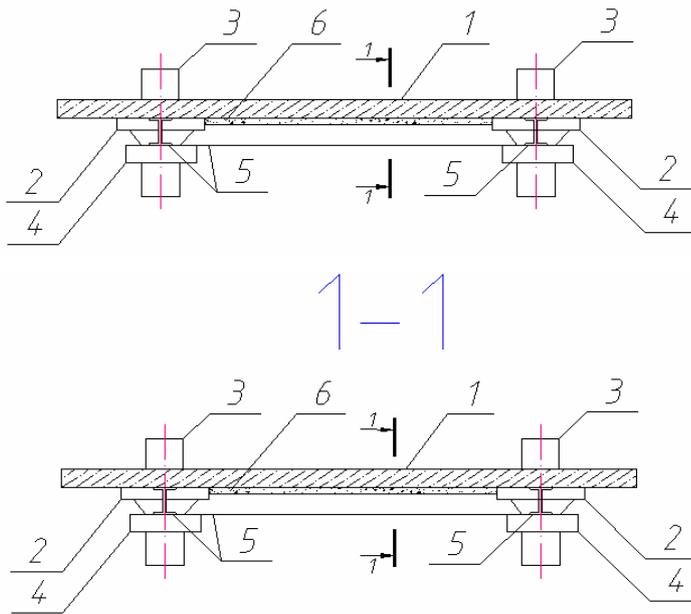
Усиление монолитного безбалочного перекрытия переустройством в плиту, опертую по контуру: 1 – плита существующего безбалочного перекрытия; 2 – капители безбалочного перекрытия; 3 – колонны каркаса; 4 – опорные столики в виде железобетонных обойм вокруг колонн; 5 – разгружающие металлические балки; 6 – шов между разгружающими балками и усиливаемой плитой, зачеканенный цементно-песчаным раствором
